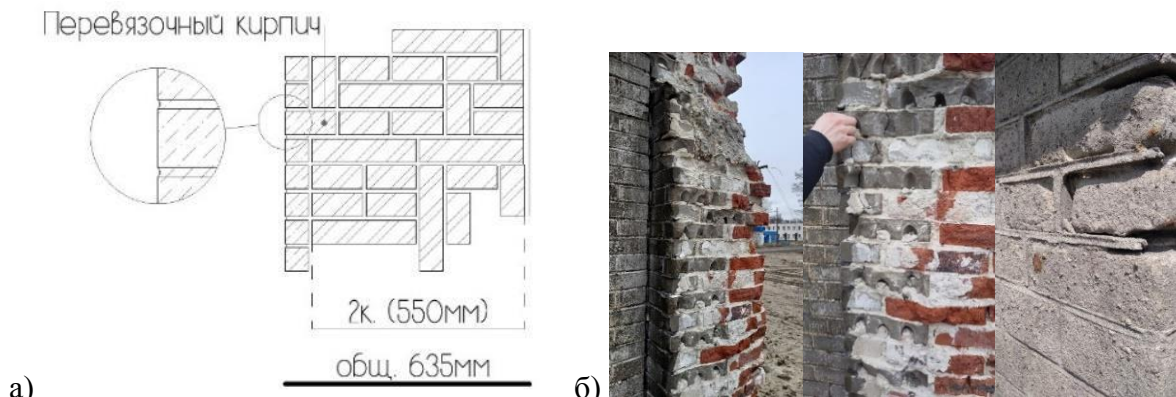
а) – конструкция наружной стены многоквартирного жилого дома (схема), б) – неотапливаемого здания (фото)
